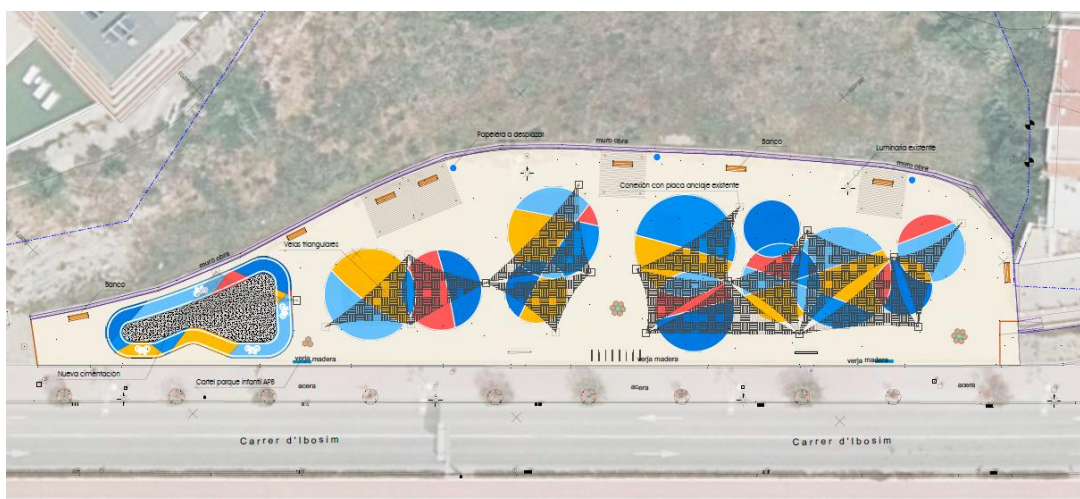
Planta propuesta para la adecuación del parque infantil de Ibosim.
